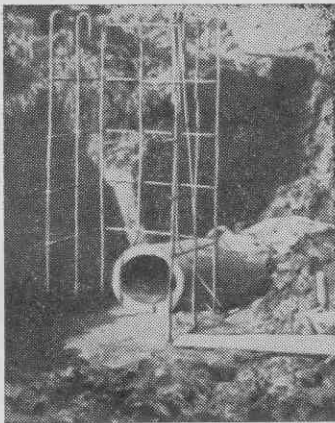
Конструкция водоспуска. Спускная труба лежит на фундаменте, вставлен железный каркас, можно устанавливать опалубку.
